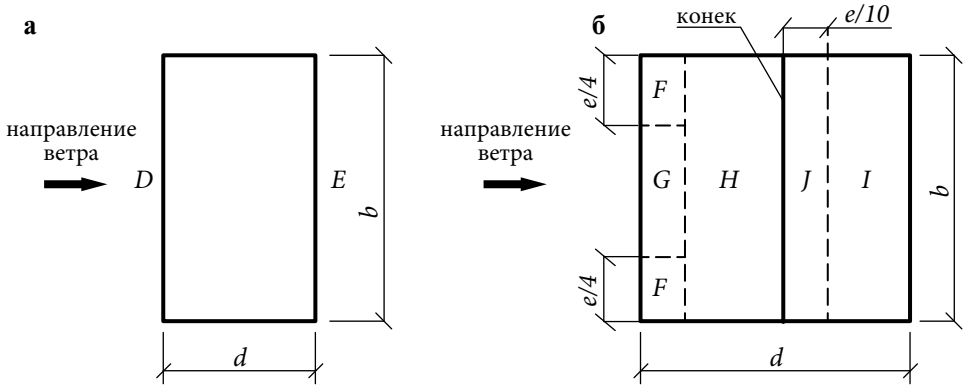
Зоны с разными аэродинамическими коэффициентами: а) для стен здания; б) для кровли здания
